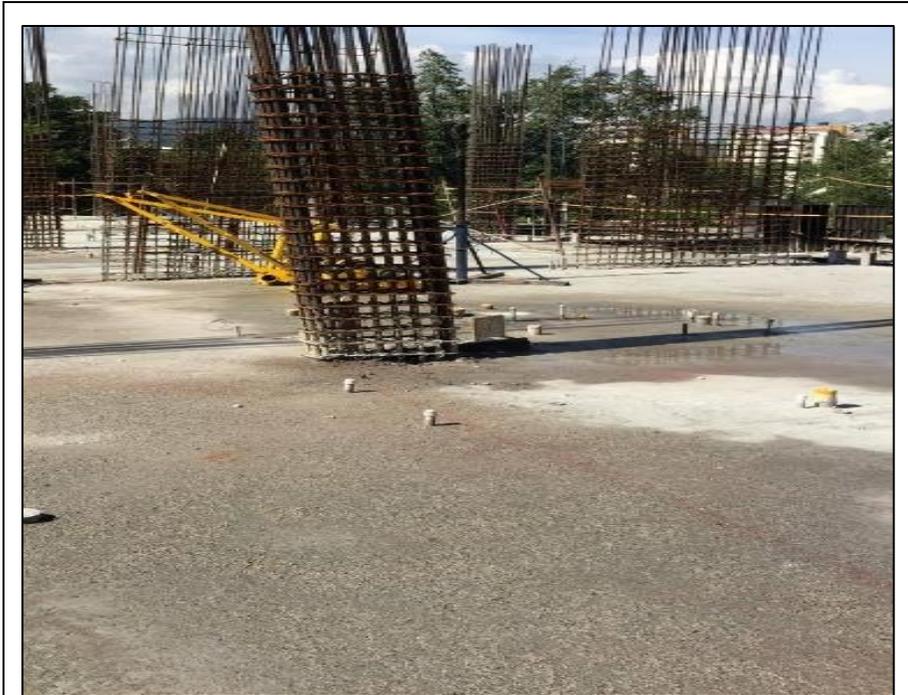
Curado del concreto - Piso 6 (N+15,90).
